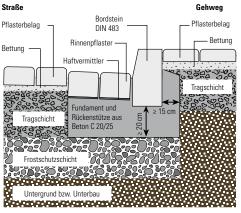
Einbaubeispiel für eine Randeinfassung mit einem Hochbordstein aus Beton und Entwässerungsrinne
